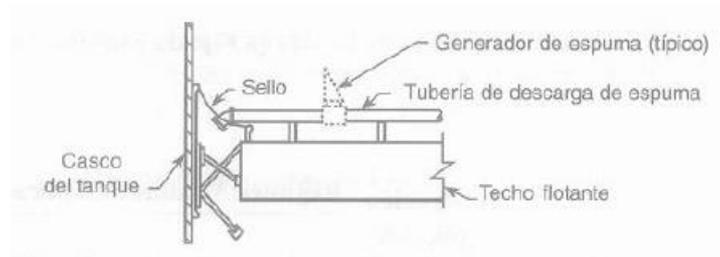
Descarga de espuma por debajo de la zapata metálica (63)
